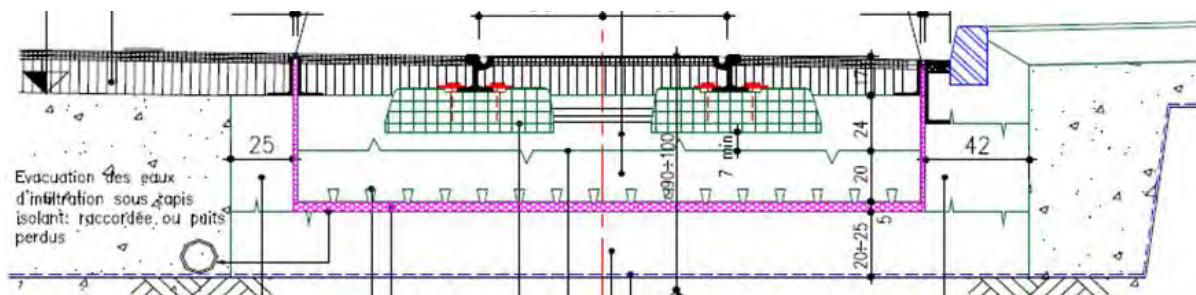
Dalle flottante lourde sur appui linéaire
